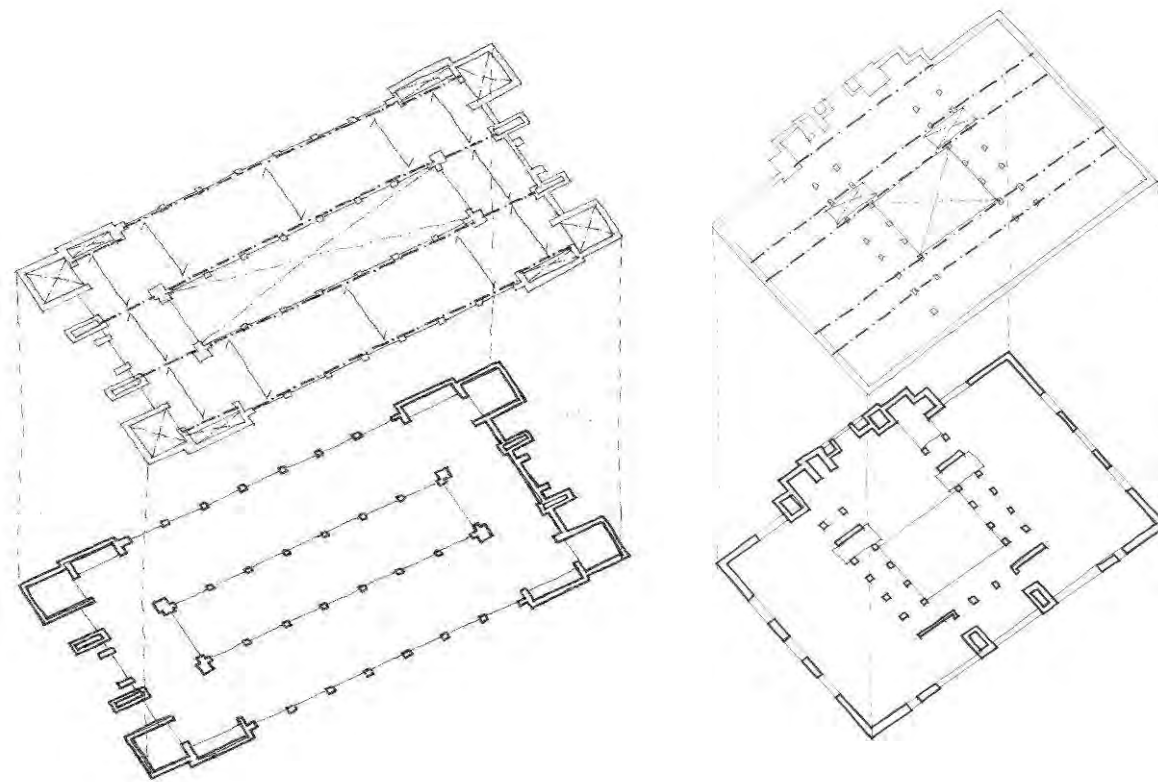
Esquema estructural del Monolithic Concrete Bank, primera aplicación integral del hormigón como estructura, cerramiento y ornamento.
